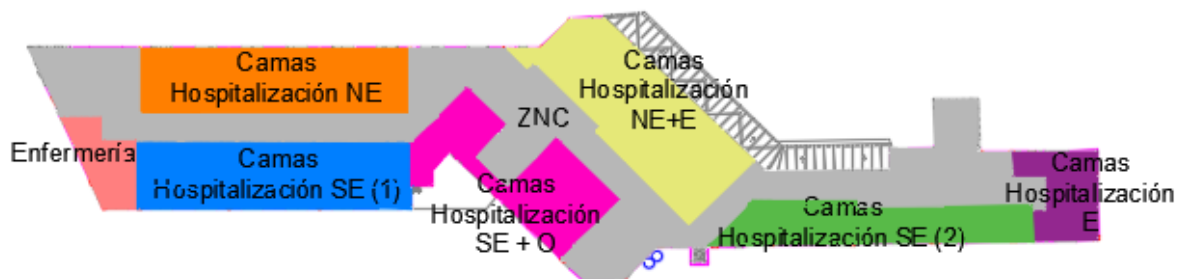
Anexo I. Zonificación planta 2 (fuente: elaboración propia).
